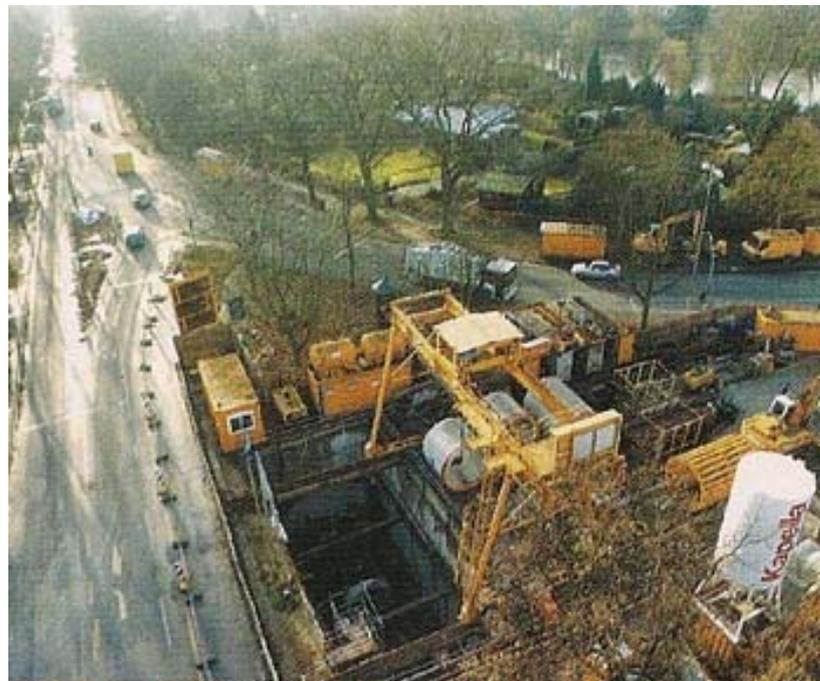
Obra de Pipe Jacking em Região Urbana, com o mínimo de interferência (restrita ao poço de cravação)
